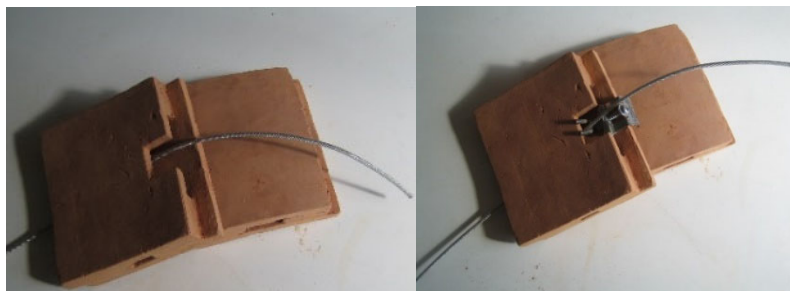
Componentes do sistema, modulo cerâmico, cabo e ferragem de compressão
